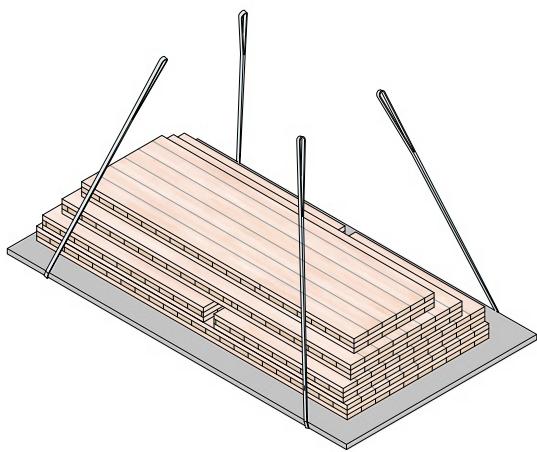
Izaje horizontal de un paquete de paneles CLT con correas de elevación Tipo 3 premontada.
